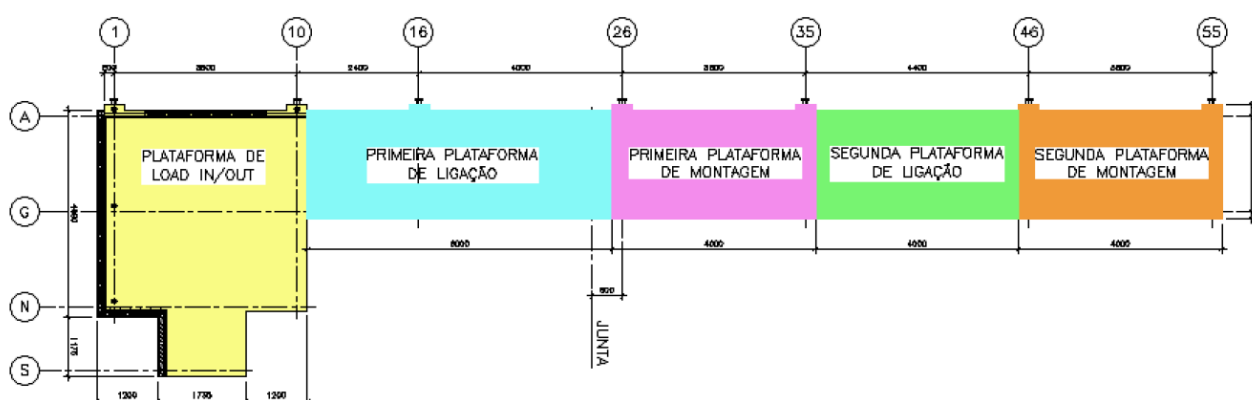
Planta Cais 1-Estaleiro Honório Bicalho (detalhe)
